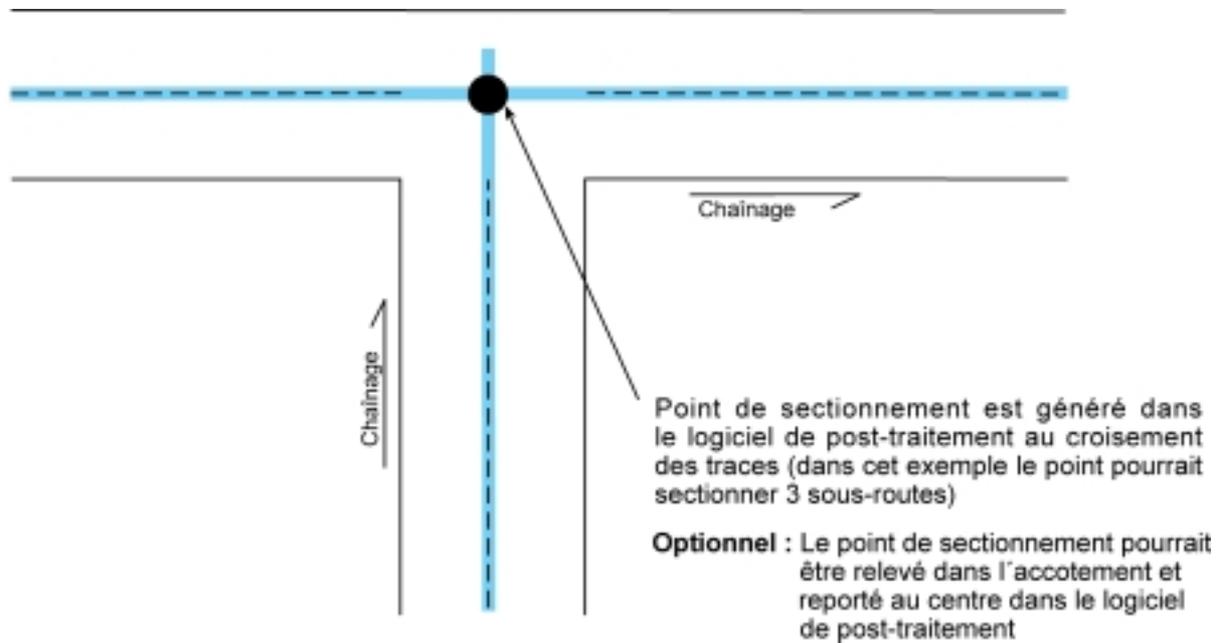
Point de sectionnement à une intersection en « T » (une sous-route contiguë sectionnée à l'intersection de chaussées séparées)
